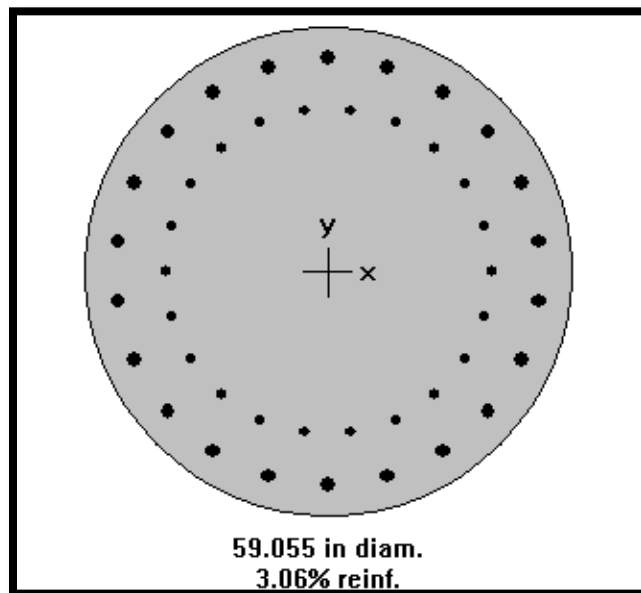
Sección de columna para diseño caballete No.1
